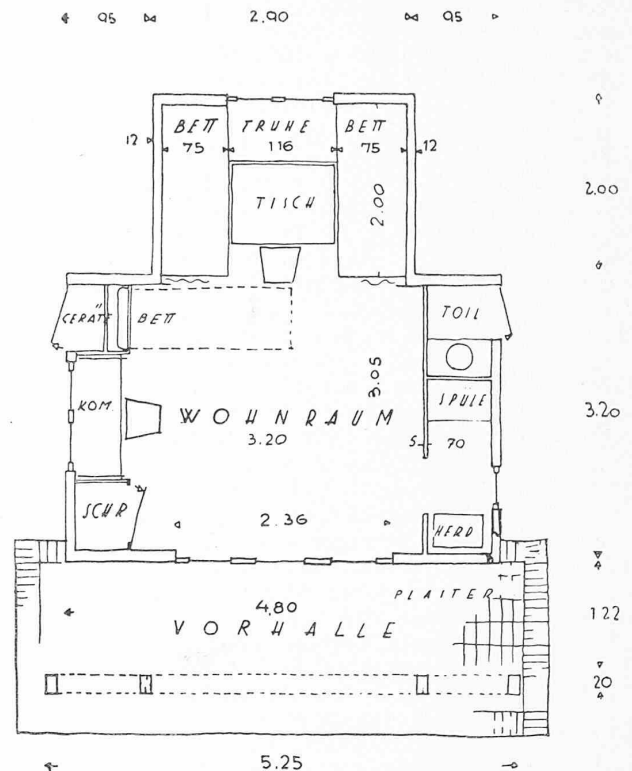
Grundriss zu Abbildung 1. Masstab 1:75.
